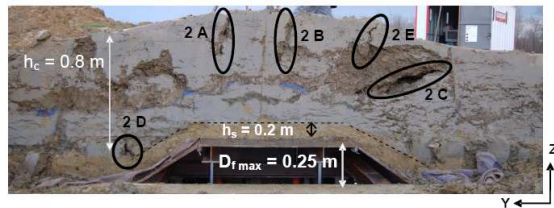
Coupe verticale de la planche T2 à la fin de l'essai d'après Camp (2008).
